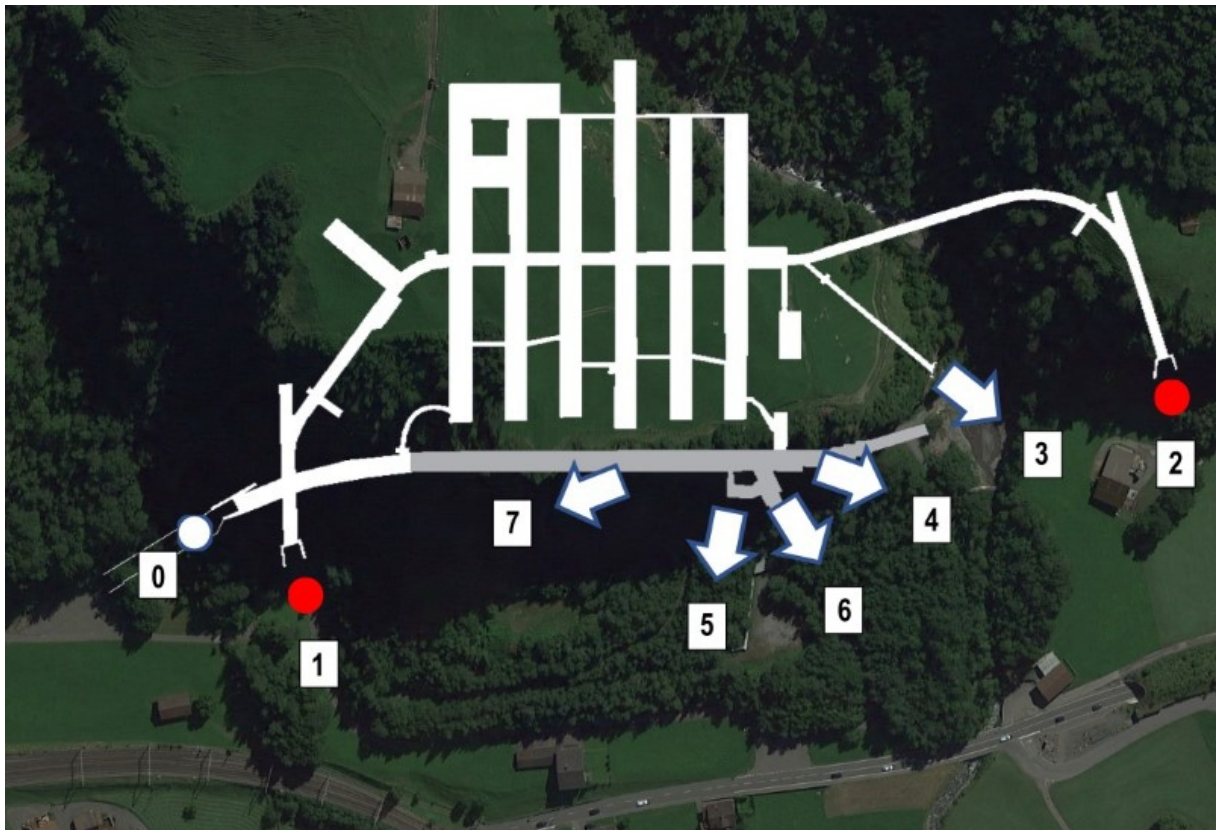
Orte mit Dämmen (rote Punkte) – Teil 1
